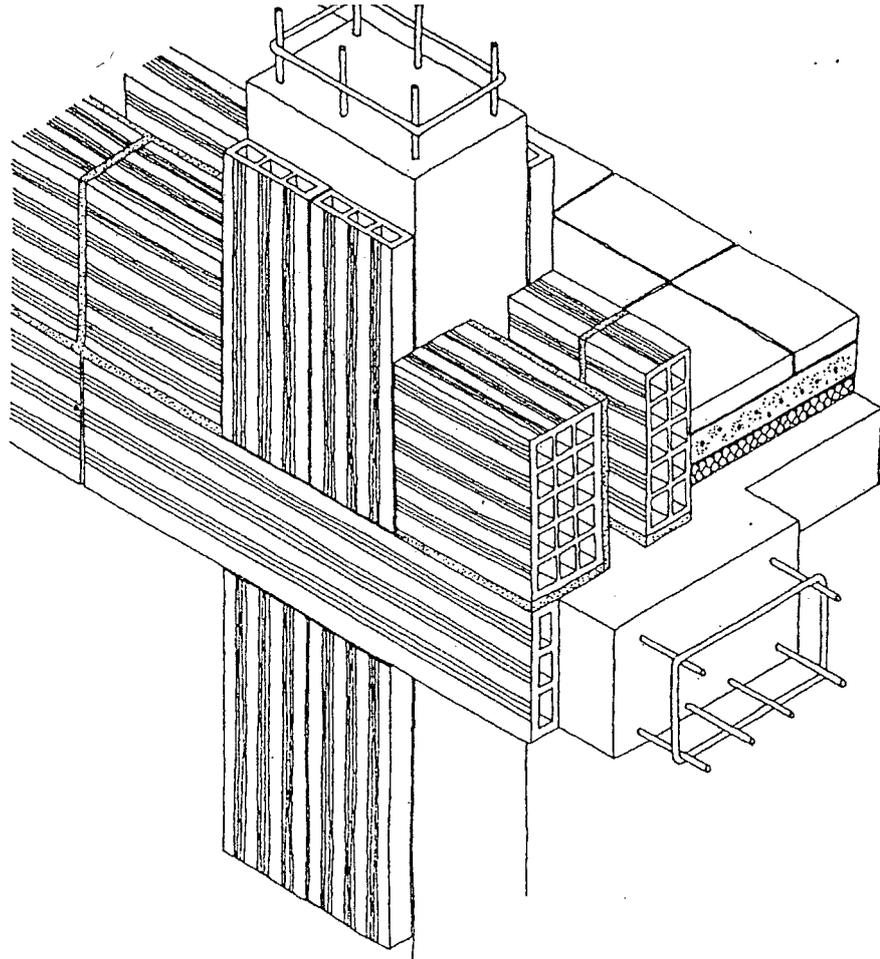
Assonometria in corrispondenza di un nodo pilastro-trave in c.a. con il tamponamento realizzato in muratura doppia con elementi forati di laterizio. La struttura è rivestita internamente (pilastro) ed esternamente (pilastro e trave) con tavelle o tavelloni in laterizio.
